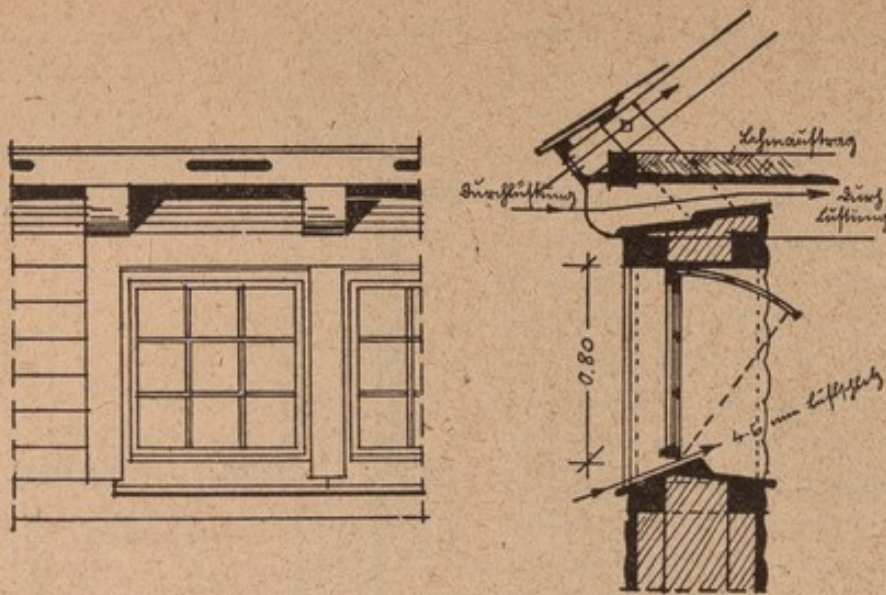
Doppelte Holzwand mit Fenster, Durchlüftung und Dachanschluß
